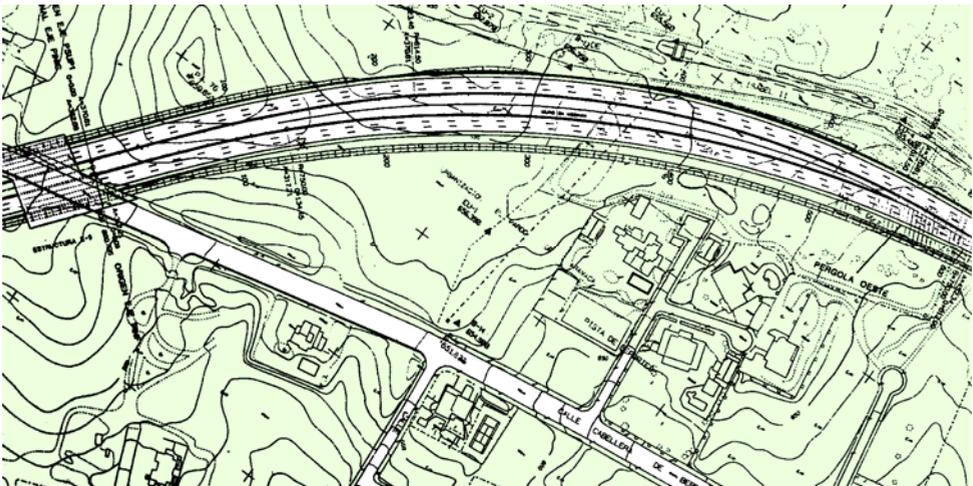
Planta de trazado de una vía de calzadas separadas
